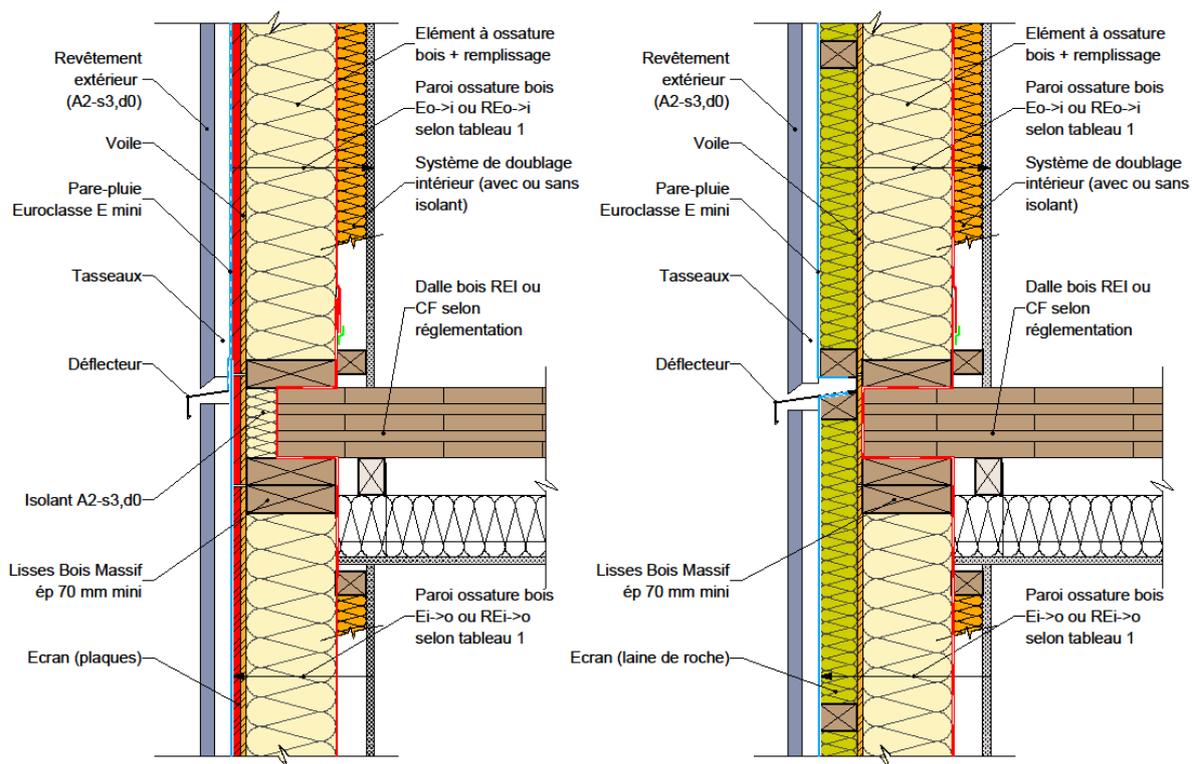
Façade/mur en ossature bois & plancher en panneaux bois massif.
